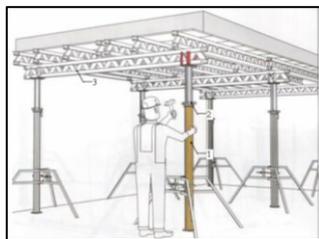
Опускание настила опалубки: 1-основная стойка; 2-регулирующая гайка; 3-продольная балка
